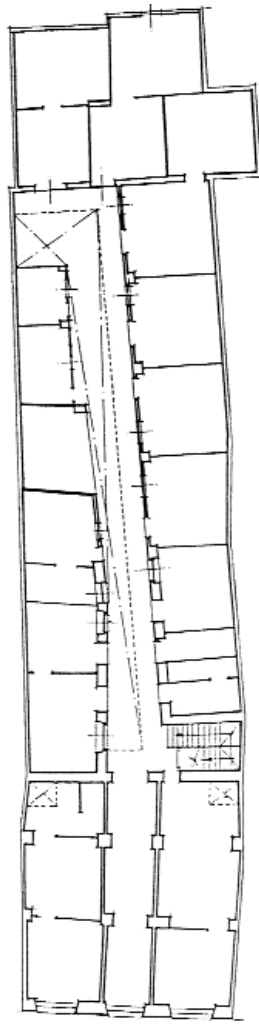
Plano de la estructura de la planta baja de la Casa Alta correspondiente al solar de calle Castilla, nº 158 (Triana, Sevilla).
